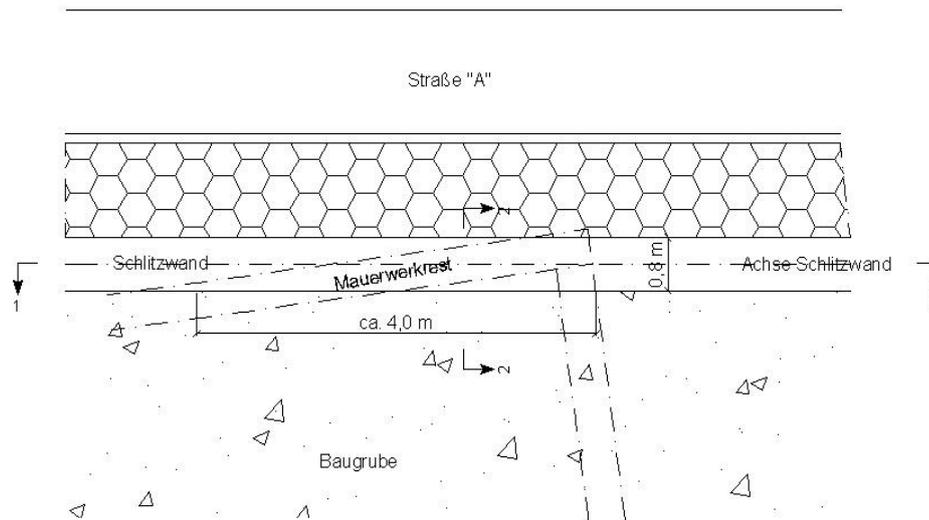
Lageplan der Schlitzwand im Bereich des Mauerwerkrestes
